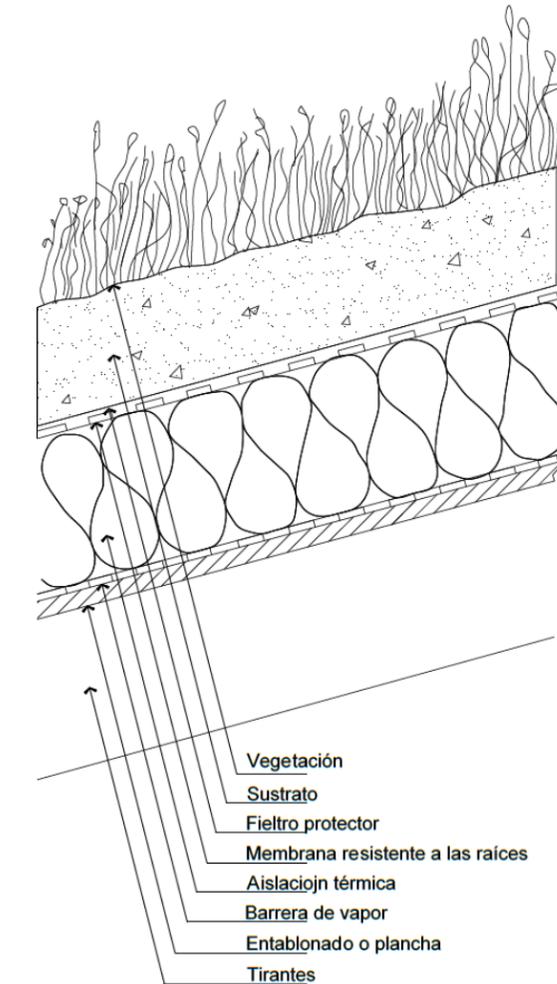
Partes de un techo verde extensivo. Fuente: Gernot Minke, Techos verdes.
